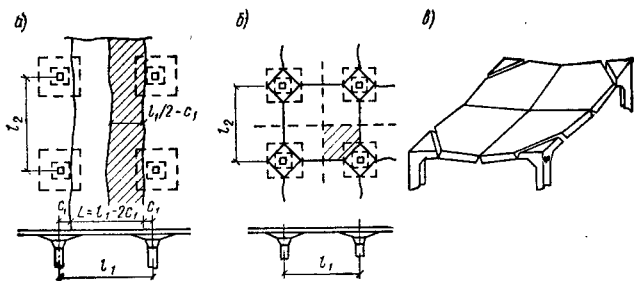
К расчету безбалочного перекрытия по методу предельного равновесия
